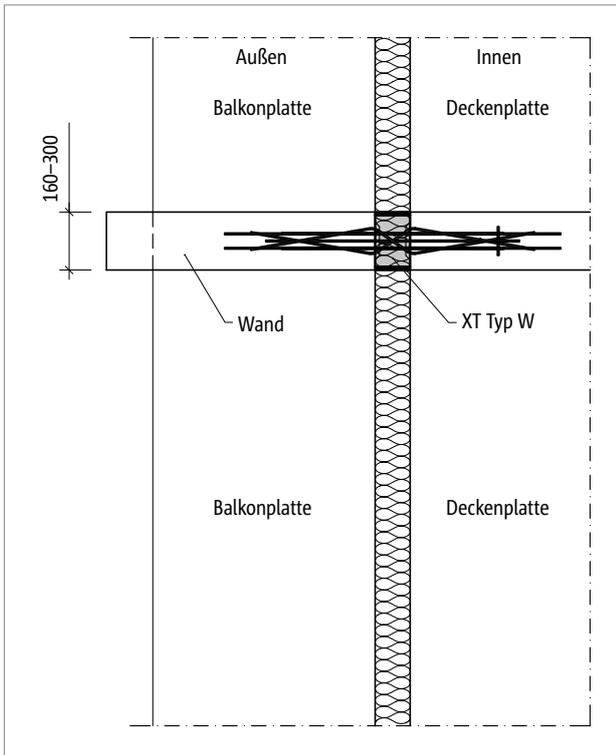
Schöck Isokorb® XT Typ W: Grundriss; Balkonkonstruktion mit wärmeisolierten tragenden Wandscheiben
